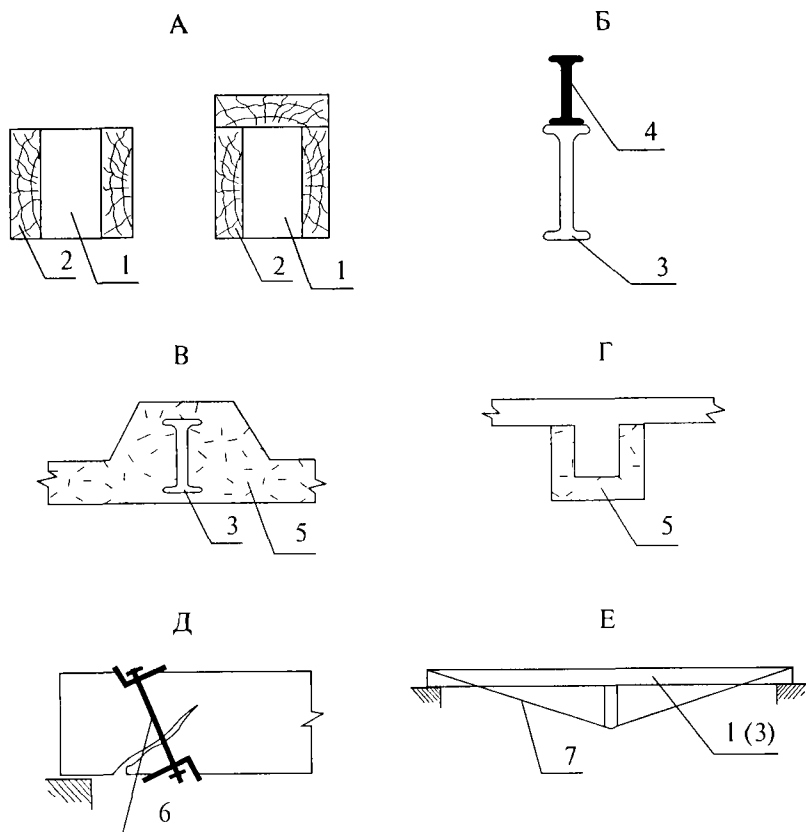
Основные методы восстановления и усиления перекрытий
